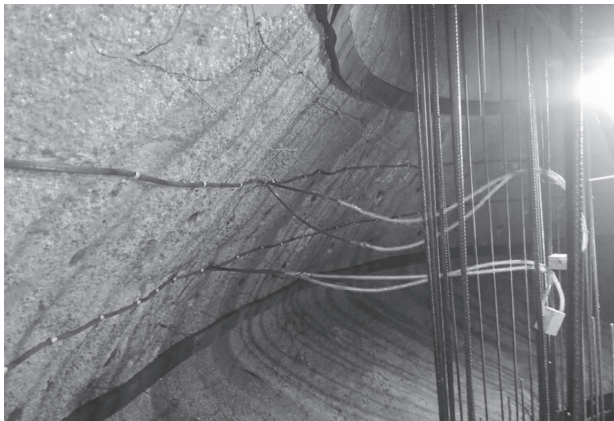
Ausbildung des Dichtschotts hinter der Innenschale
